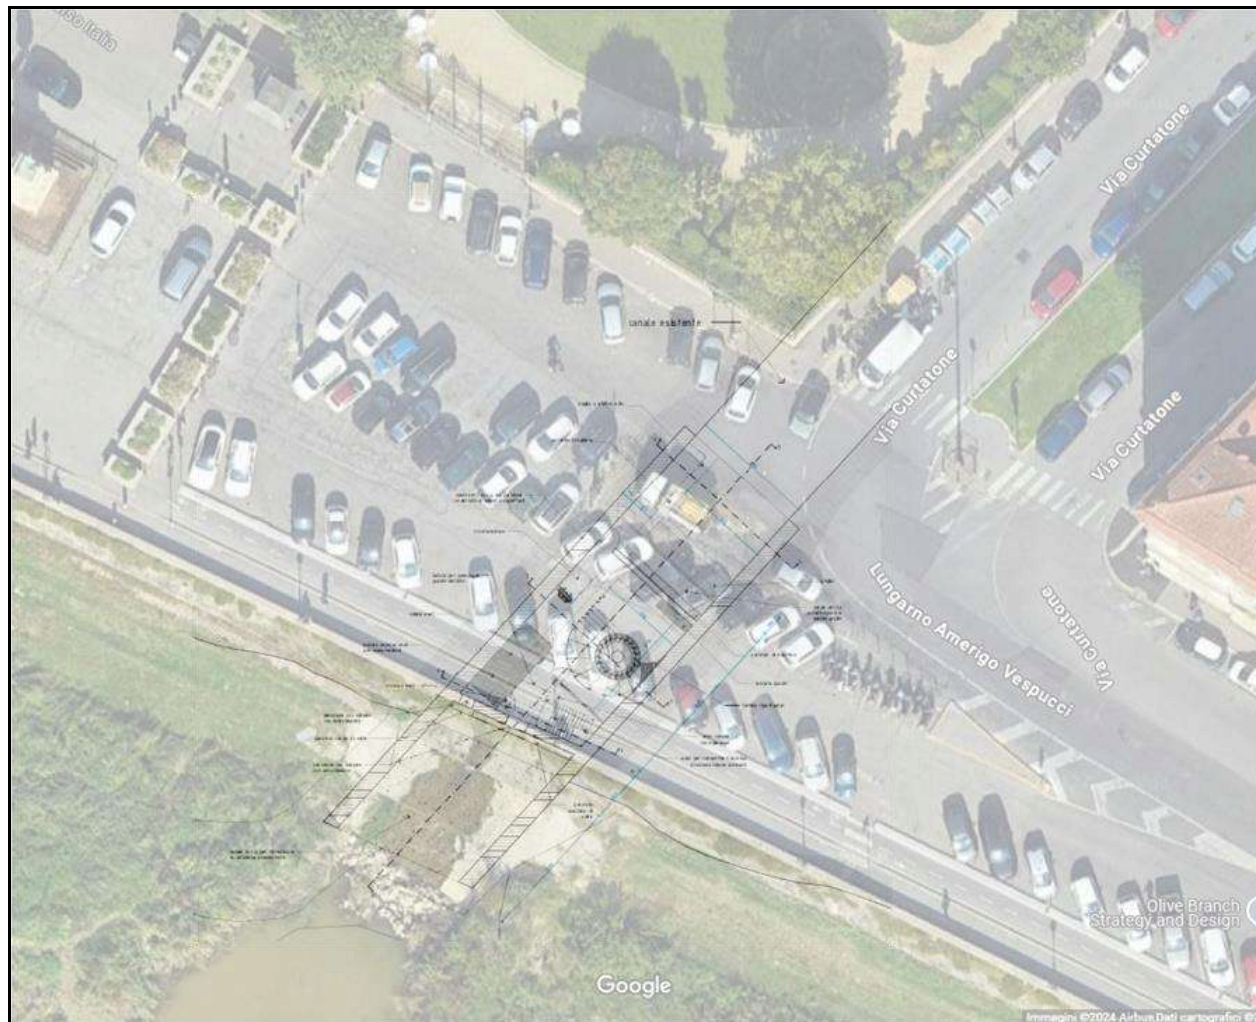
Planimetria sovrapposta dello stato di progetto dell'opera
